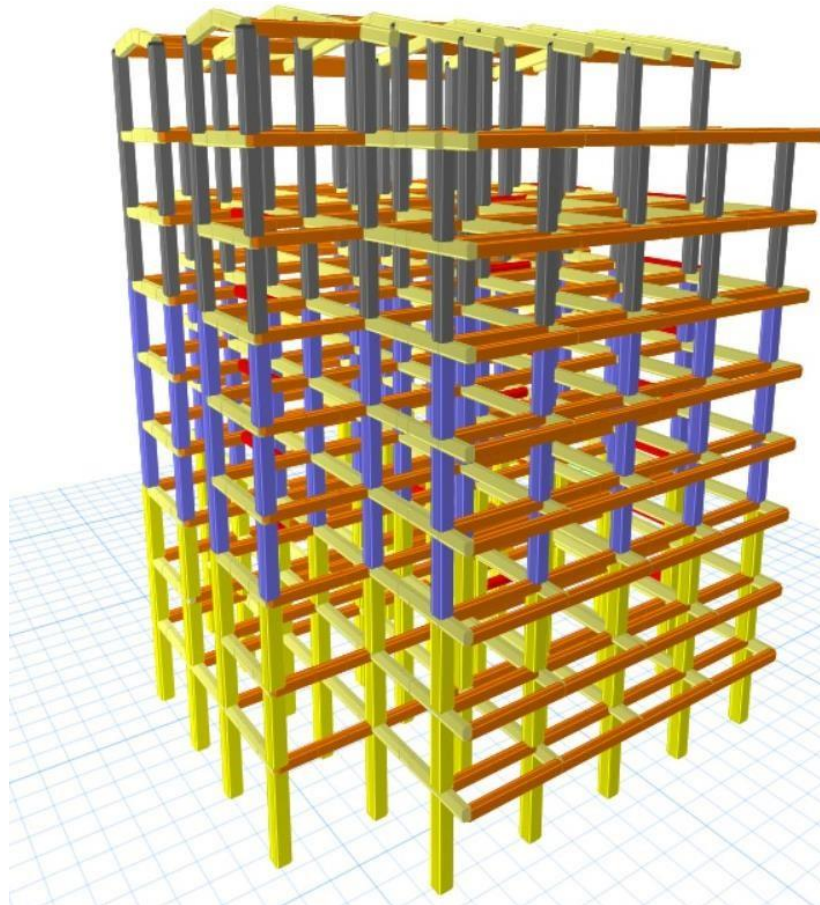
Visualisation en 3D des poutres et des poteaux.
